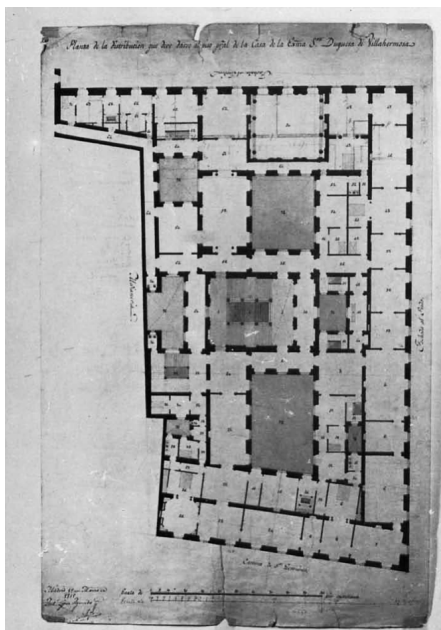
Antonio López Aguado: Planta de la distribución por el proyectada en 1805 para el piso principal. Archivo de Villahermosa.
